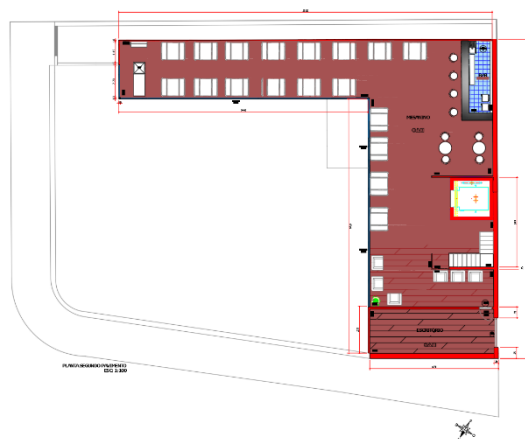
Planta Segundo Pavimento (Fonte: Produção do autor)
